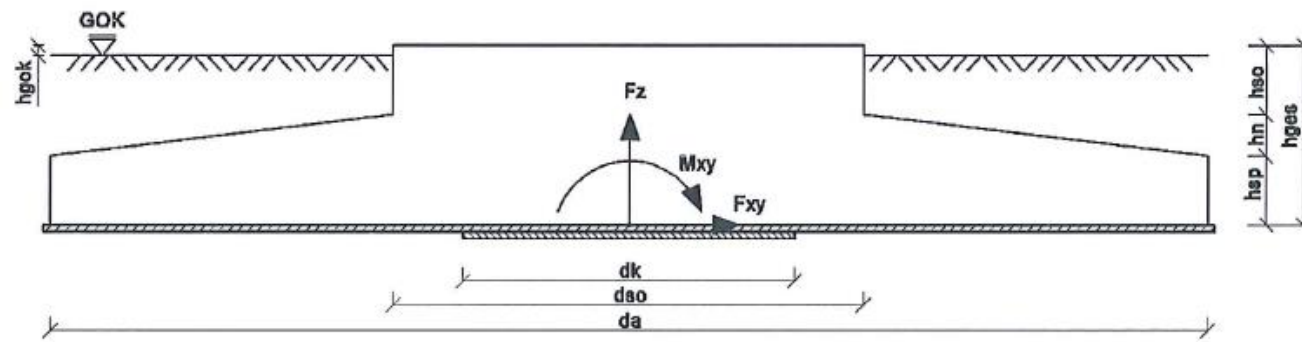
Plans des fondations de l'éolienne de type E-82 E4 – 110m (Source : ENERCON)
